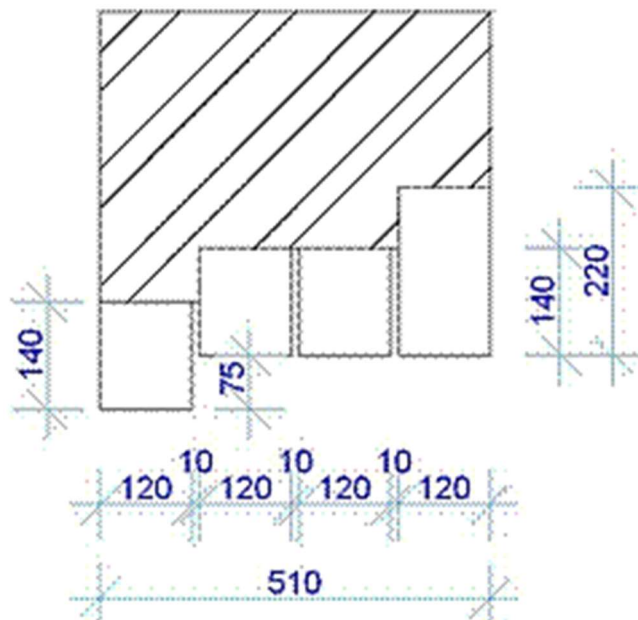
Схема раскладки перемычек в несущей наружной стене толщиной 510 мм
